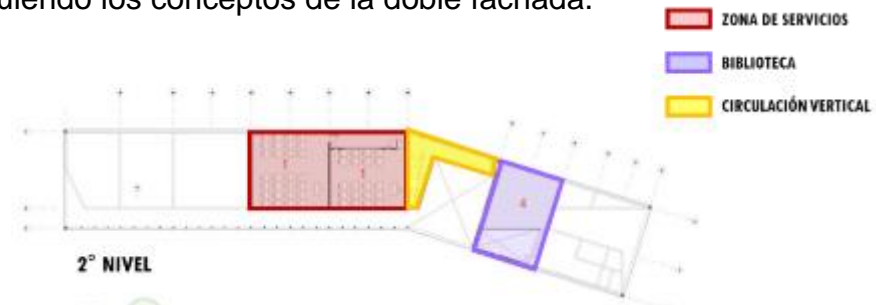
Planta arquitectónica de 2° Nivel. Fuente: Archivo Construye Identidad.
